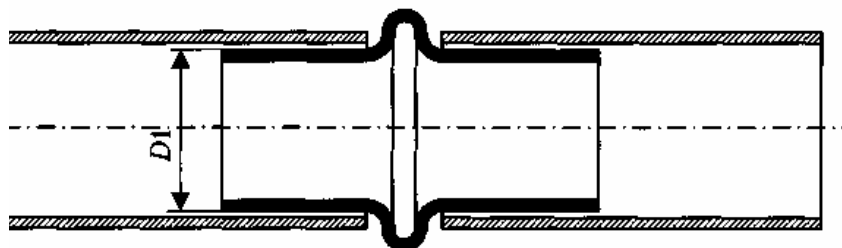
Ниппельное соединение круглых воздуховодов
